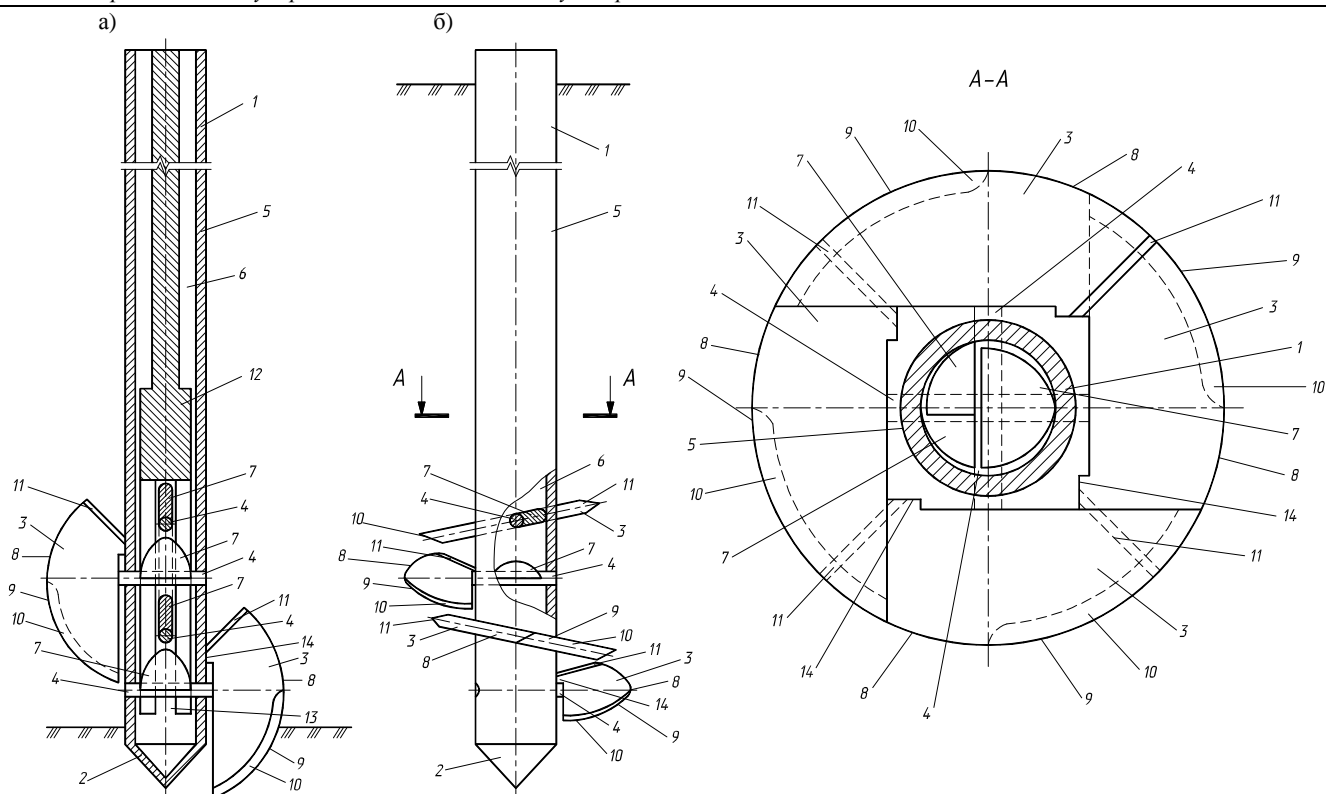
Схема сваи с вертикальными поворотными лопастями, располагаемыми по винтовой линии:
